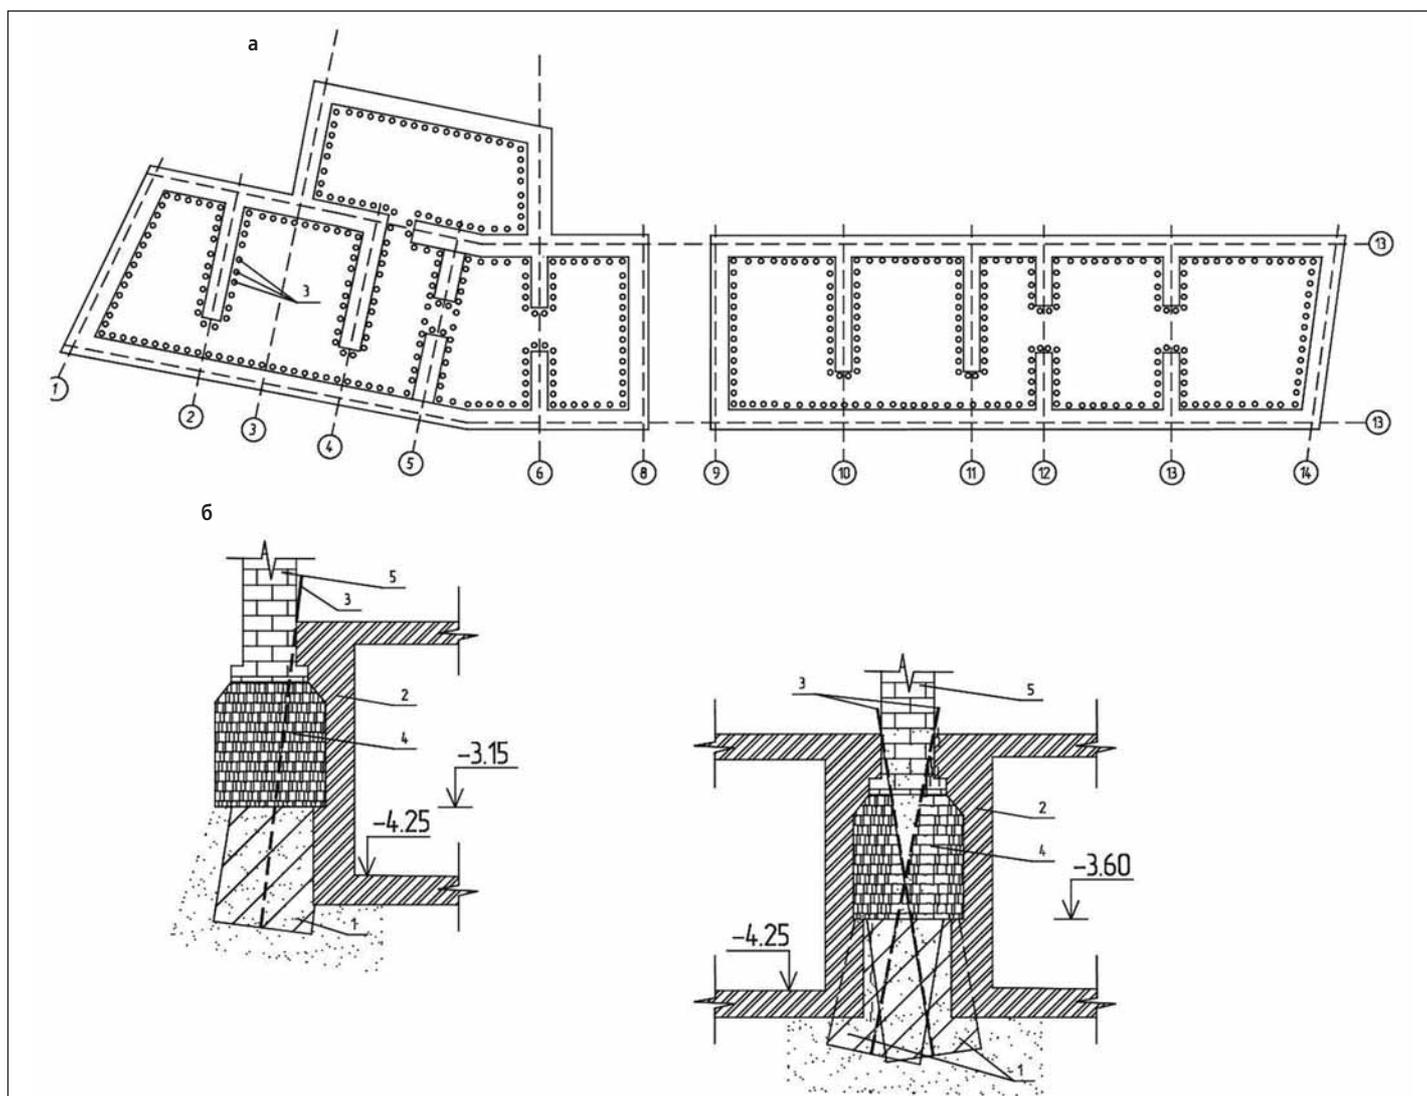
План подвала реконструируемого здания по Нижнему Кисловскому переулку: а – план подвала; б – схема укрепления грунтов: 1 – закрепленный грунт; 2 – новые конструкции подвала; 3 – манжетные колонны; 4 – бутобетонная кладка фундамента
